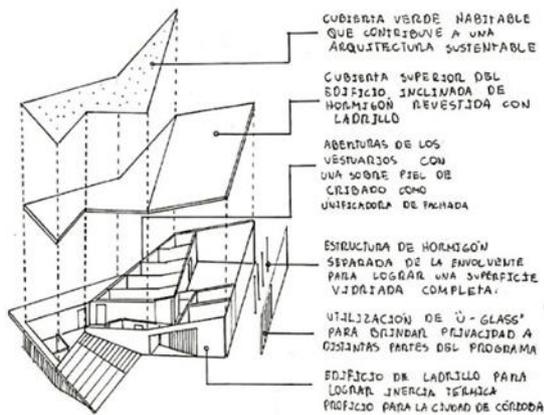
Despiece constructivo del Proyecto. Imagen de los voladizos de hormigón.
